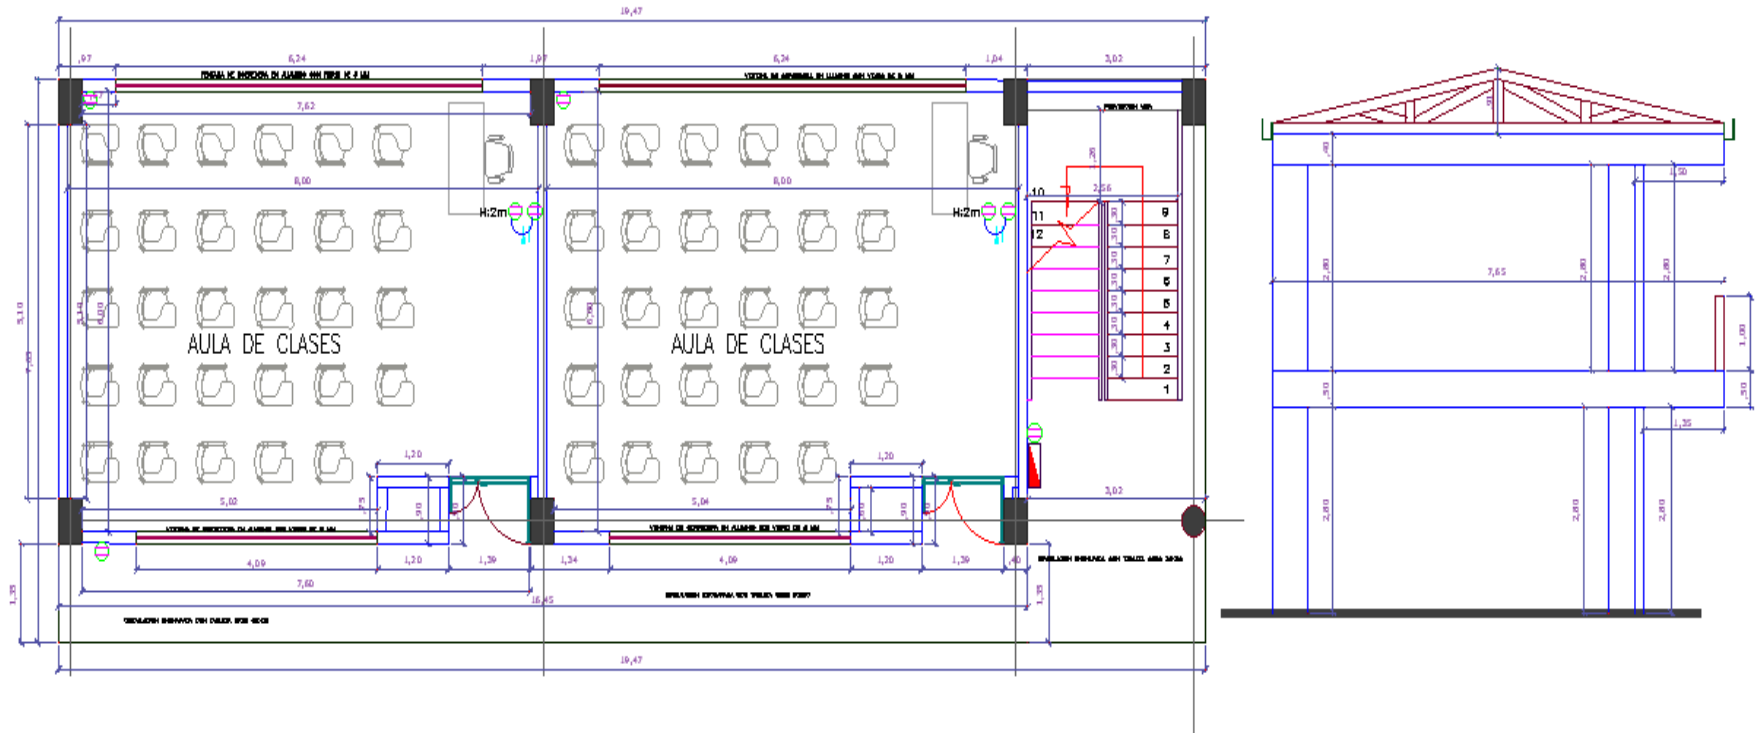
Plano arquitectónico del primer nivel y perfil izquierdo de la edificación (Elaboración propia).
